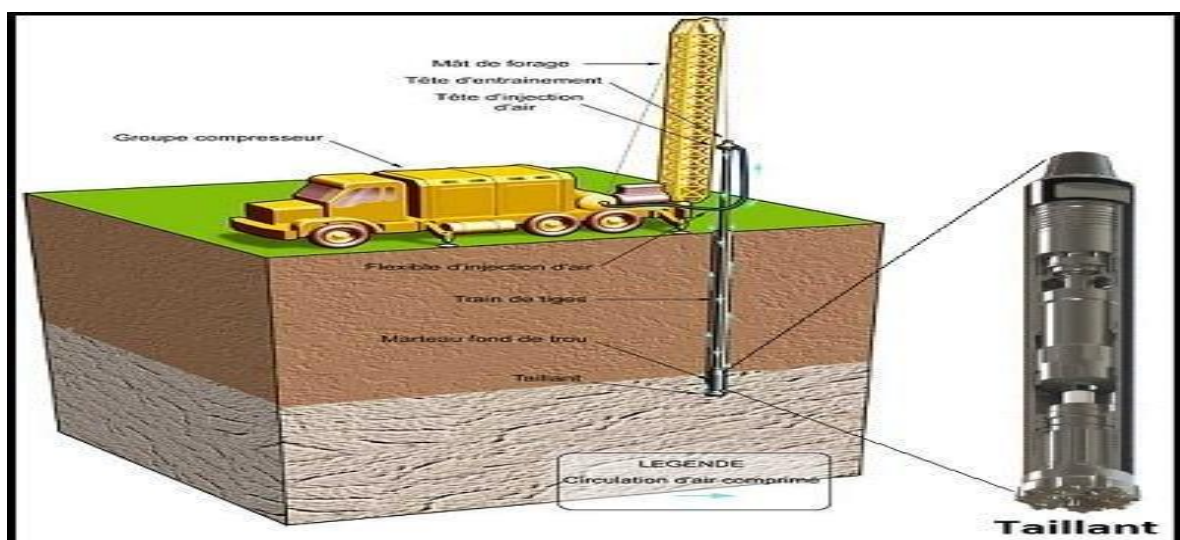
schéma simplifié d'une installation de forage fond de trou (MFT)
